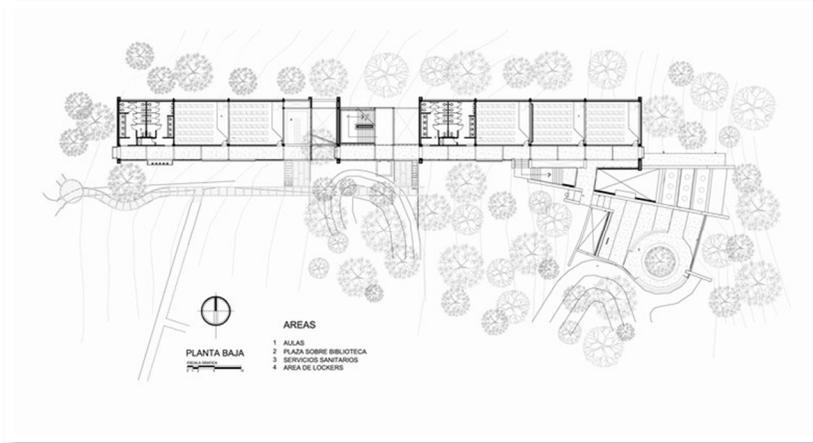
Plano Planta Baja de la preparatoria que muestra la organización de los espacios
